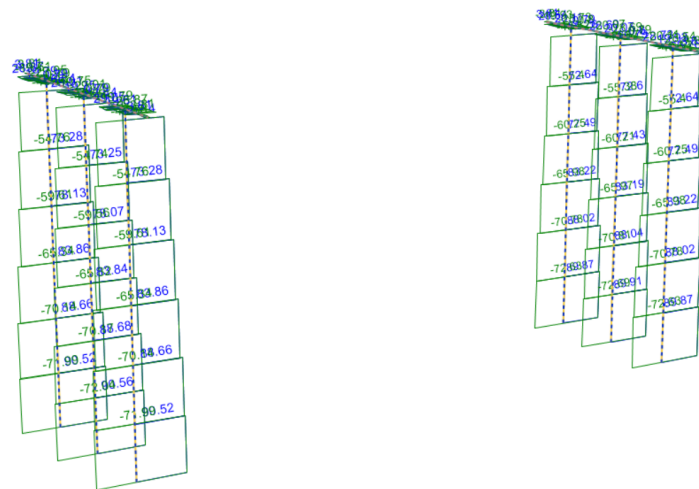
Fuerza Cortante Longitudinal en Pilar (H=21.00m) Evento Extremo I (Fz)
